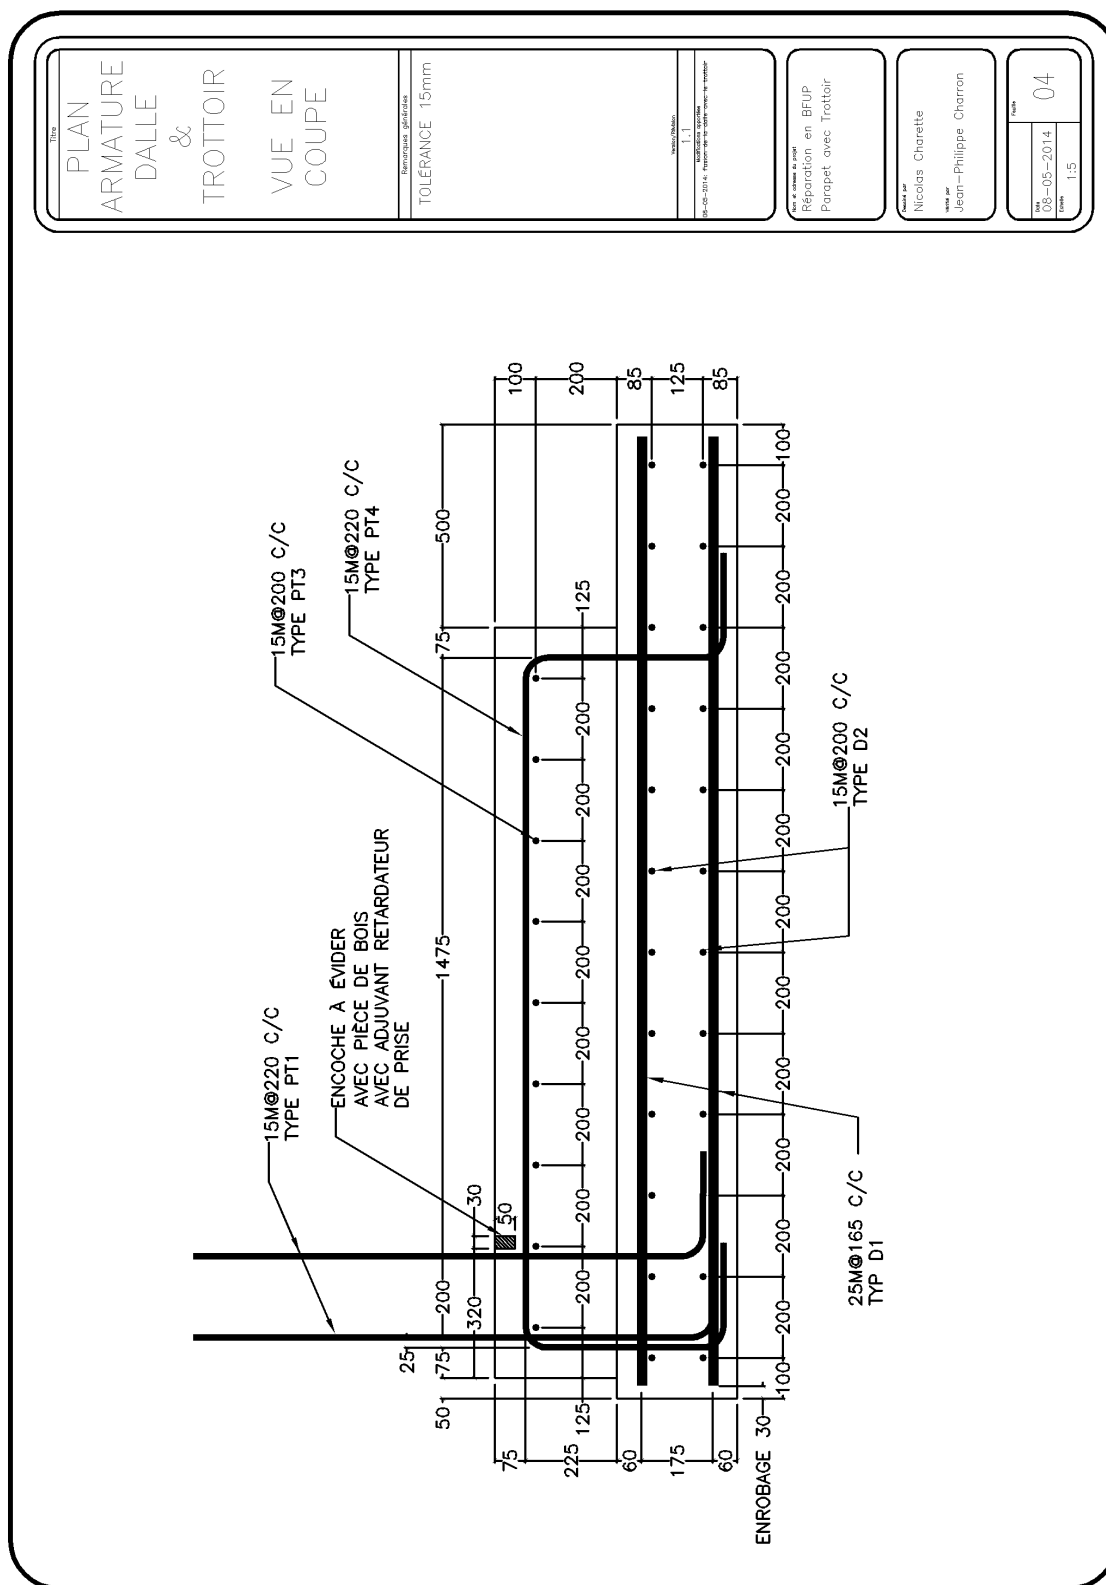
Plan d'armature dalle et trottoir - Vue en coupe
